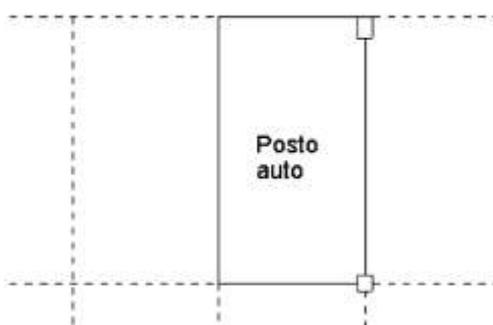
Estratto planimetria catastale, relativa al posto auto sub. 151
